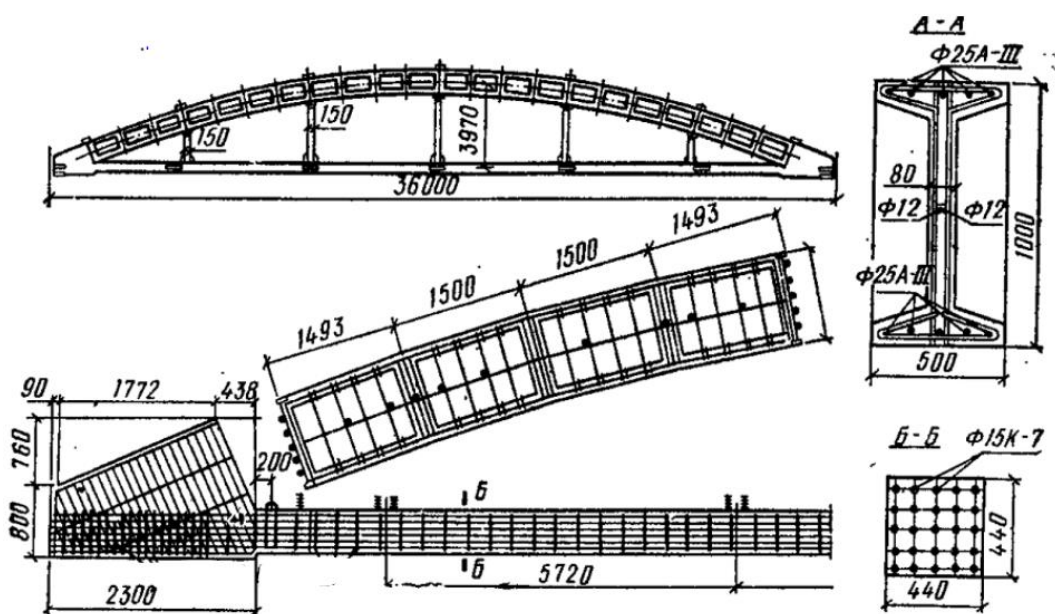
Збірна залізобетонна арка покриття з затяжкою прольотом 36 м
